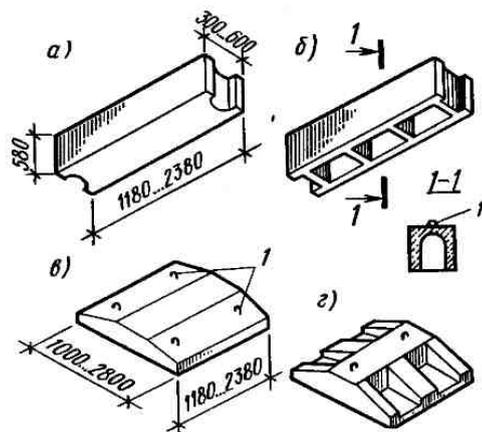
Элементы сборных бетонных и железобетонных фундаментов:
